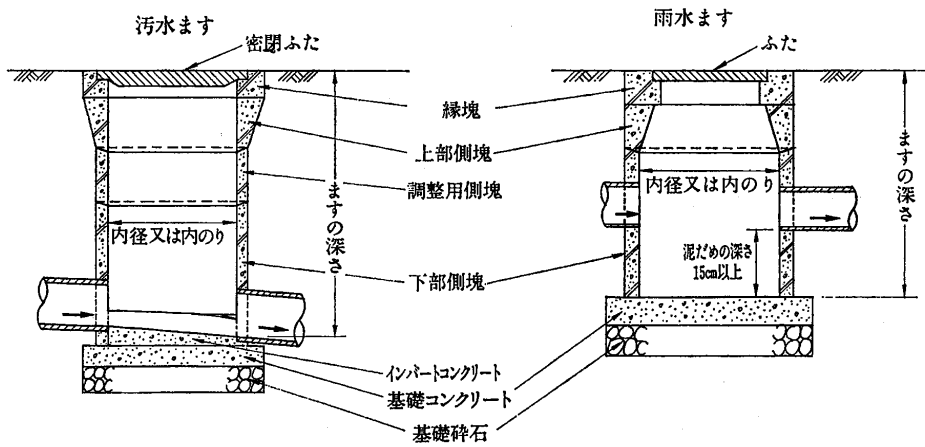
鉄筋コンクリート製ますの例(一部現場施工、既製ブロック使用)
